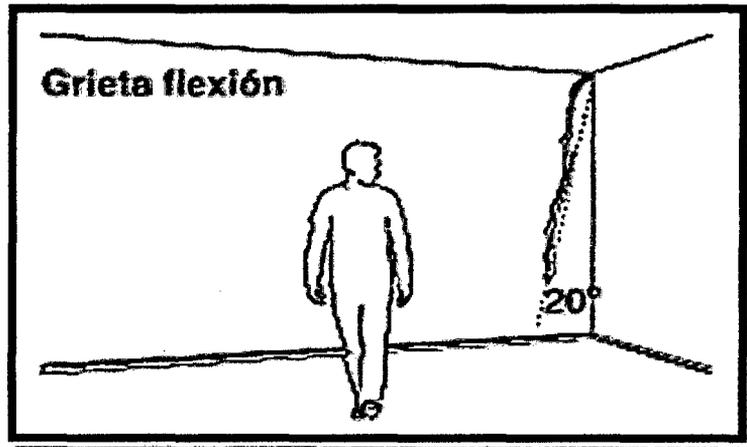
Grieta por Flexión (Vigouroux 2010)
